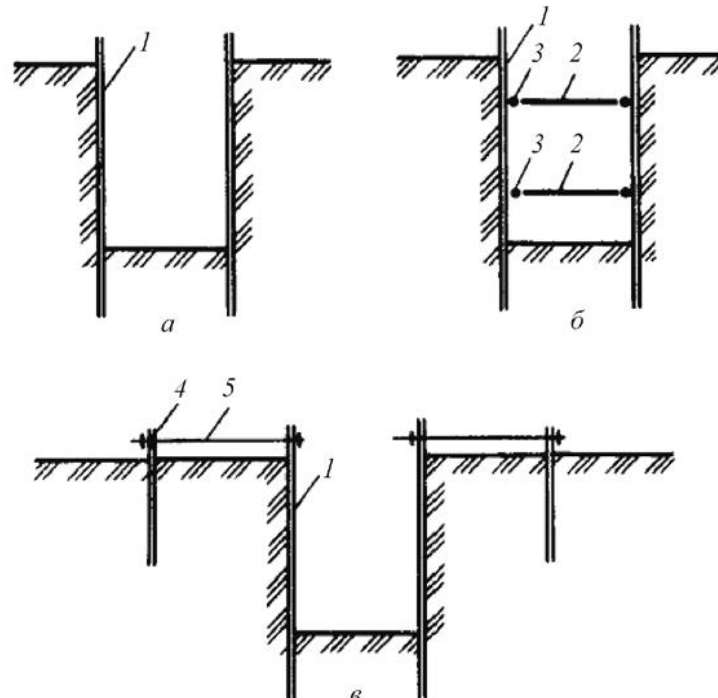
Кріплення вертикальних стінок виїмок:
